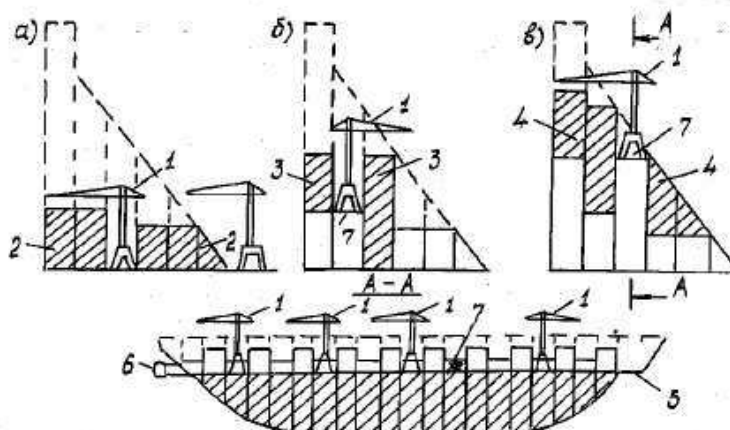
схема размещения бетоноукладочных кранов на сооружении.
